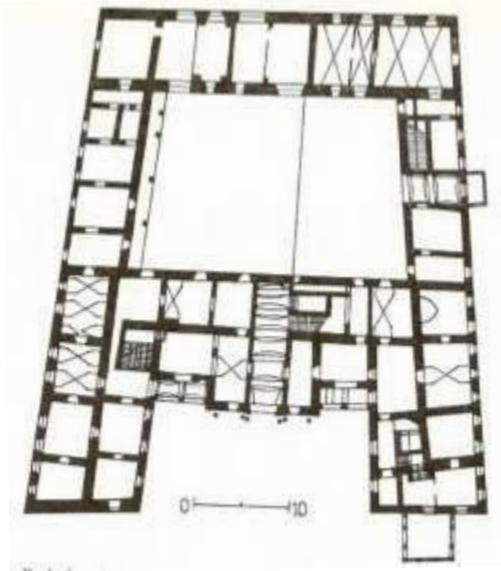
Schloss Szárasz-Rudnyánszky in Nagytéteny, Grundriss (links)
